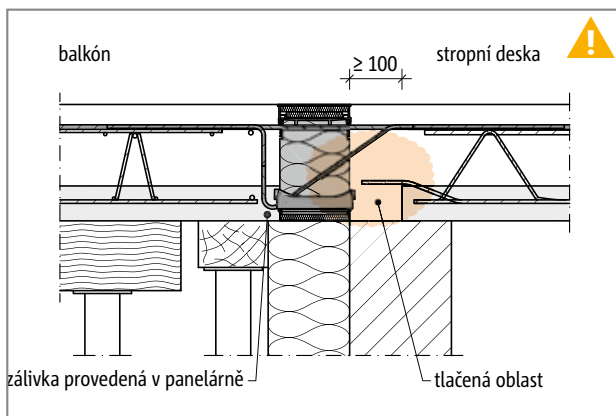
Schöck Isokorb® XT typ KL: Prefabrikovaný balkón, jehož spodní hrana je snižena vůči stropní desce uložené na předem vybetonované železobetonové stěně
